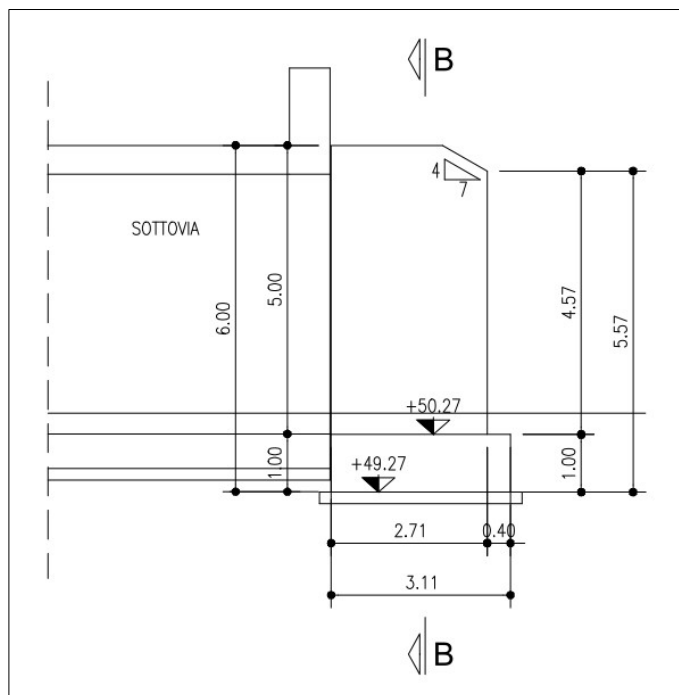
Sezione trasversale del muro d'ala – Lato Nord
